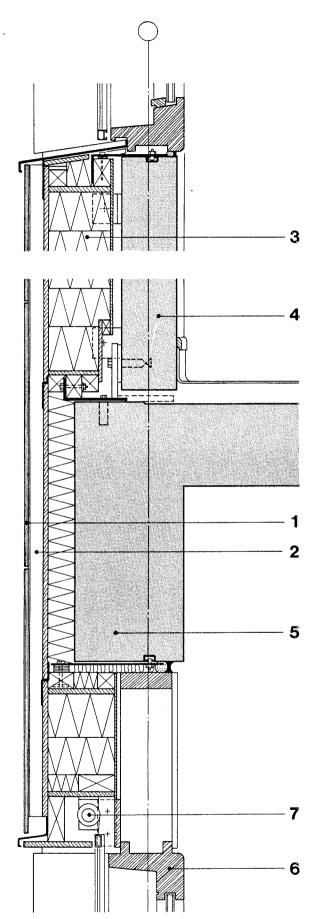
Snit gennem facade, 1:10. 1. 10 mm Eternit facadeplader, 2. 35×70 mm trykimprægnerede lægter, 3. Lavenergielement bestående af: 16 mm CSP finér, 170 mm Glasuld, dampspærre og 3,2 mm Masonite, 4. Brystningselement af beton, 5. Præfabrikeret betonbjælke, 6. Vinduer af træ, 7. Lodret markise.
